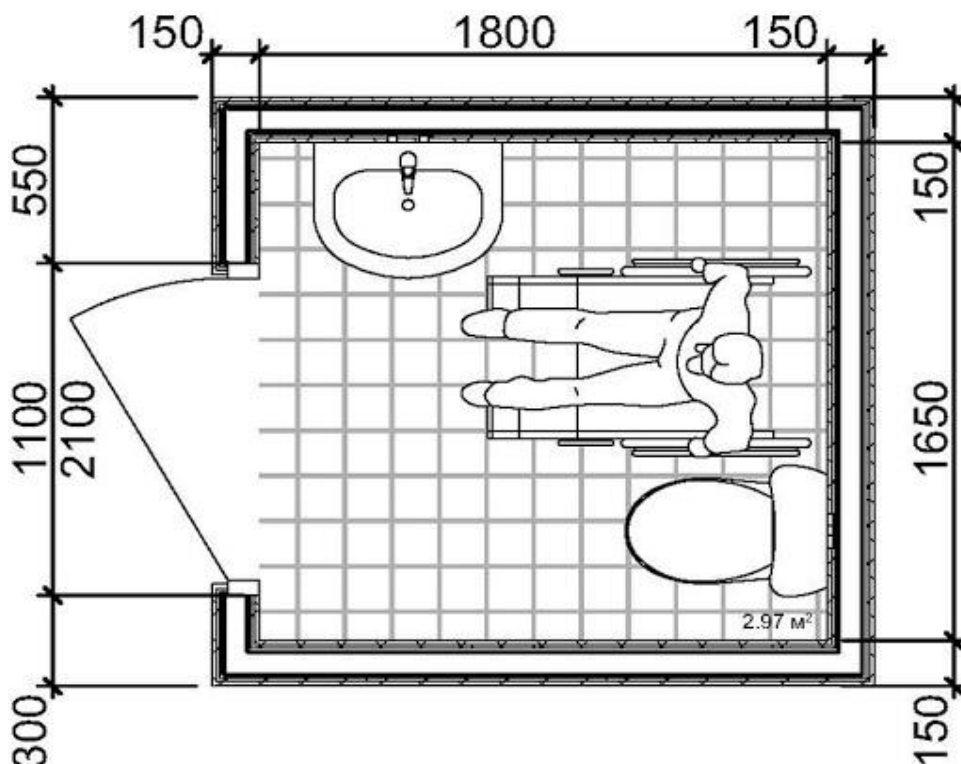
План туалета для инвалидов. Размеры сан узла и двери.
